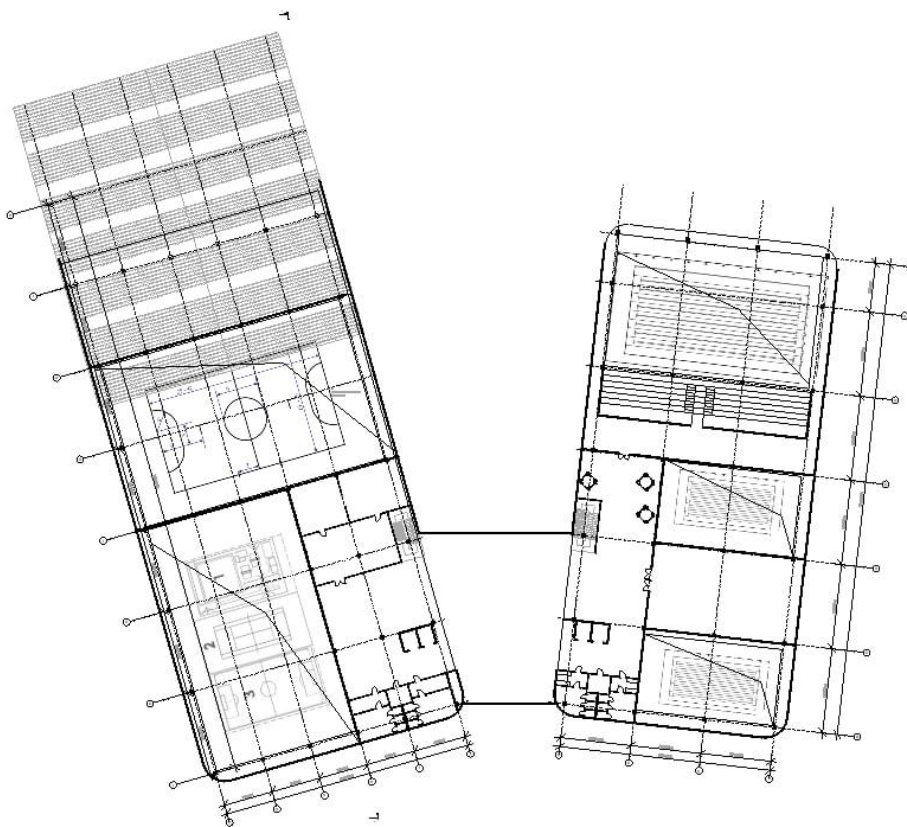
План 2-ого поверху спорткомплексу
